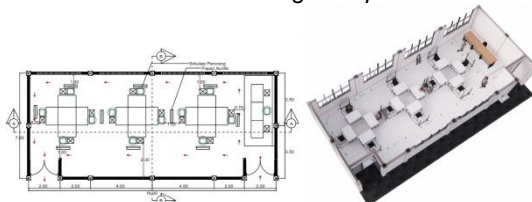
Denah Ruang 4-1 tipe Semi Circle
